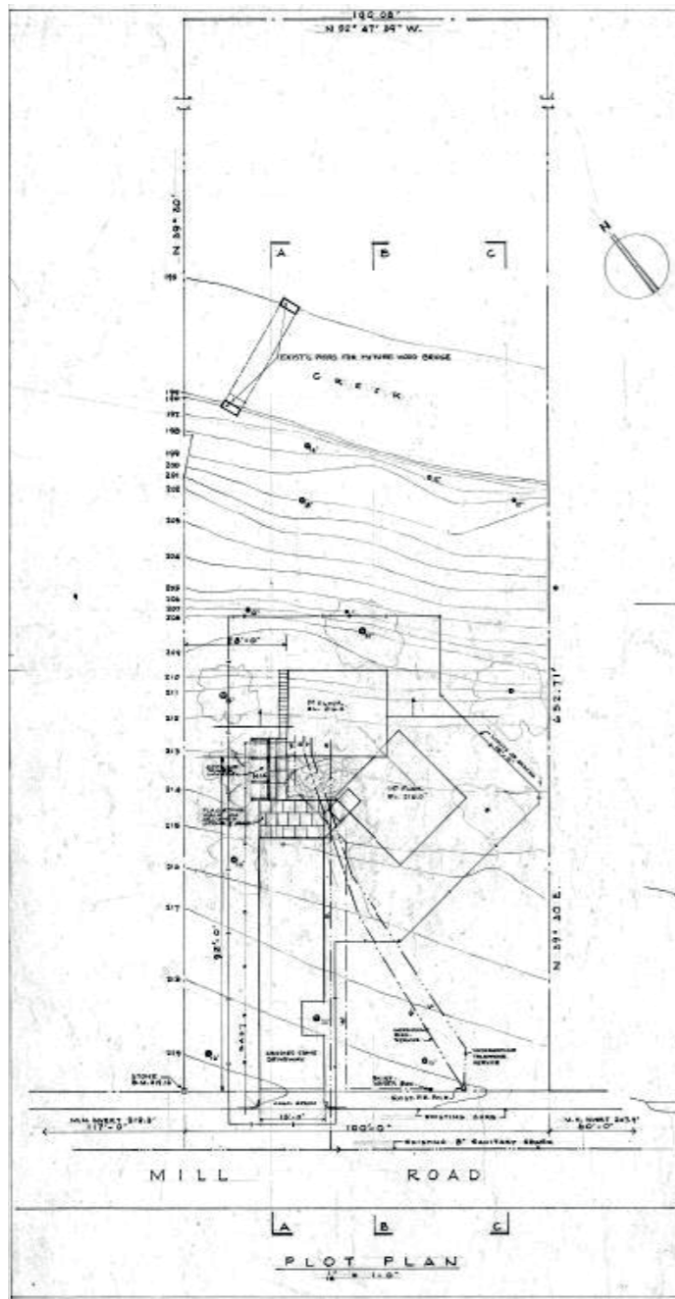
Plano de emplazamiento original ejecutado por Kahn del proyecto de la Fisher House.
